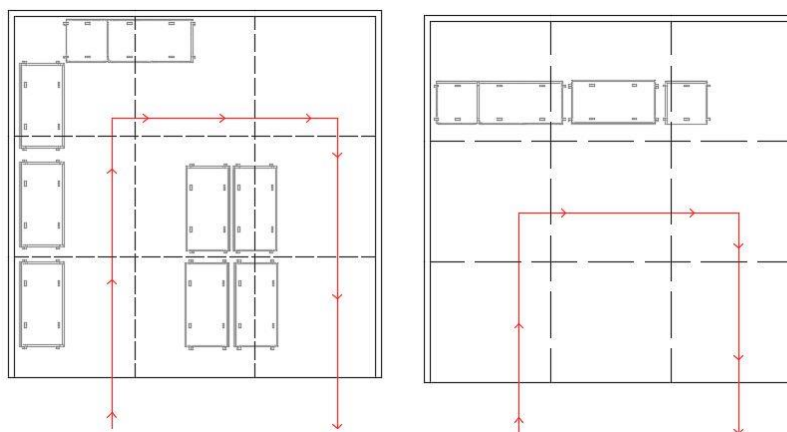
Plantas de um stand de 3x3 m com espaço de circulação e equipamento
